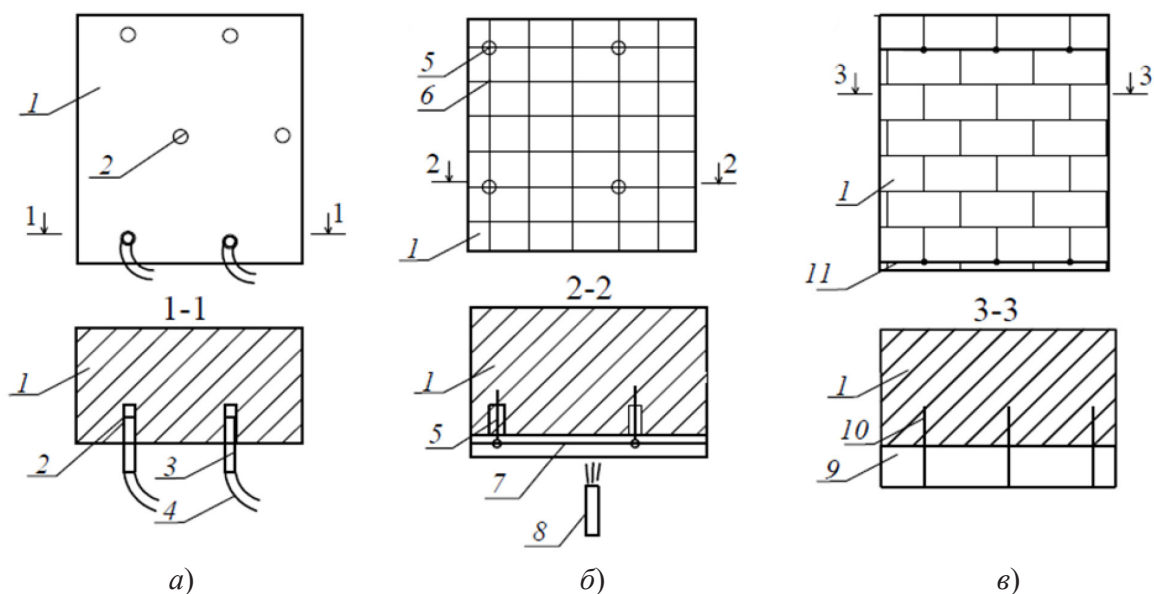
Усиление кирпичных стен армированием: *а* – отдельными стержнями арматуры; *б* – арматурными каркасами; *в* – арматурной сеткой; *1* – усиливаемая стена; *2* – шпурсы с шагом 70–80 см; *3* – инъекторы; *4* – шланг для подачи смеси; *5* – арматурный стержень  $\varnothing 10$  мм под углом  $30^\circ$ ; *6* – арматурная сетка из арматуры Вр-1 с ячейкой  $150 \times 150$  мм; *7* – торкрет-бетон; *8* – сопло для торкретирования; *9* – прикладка ряда кирпича; *10* – анкер; *11* – цоколь
